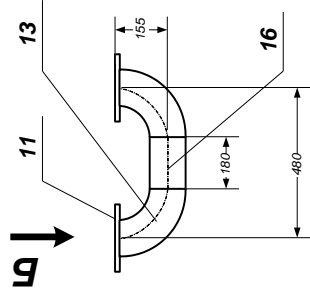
Установочный чертеж двухрядного каскада модулей
